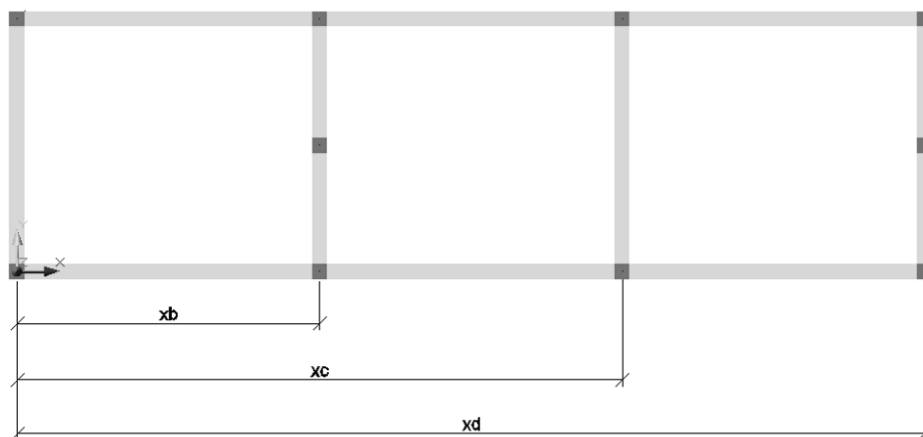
29 – Posicionamento dos pórticos em planta com relação à origem (canto inferior esquerdo).
